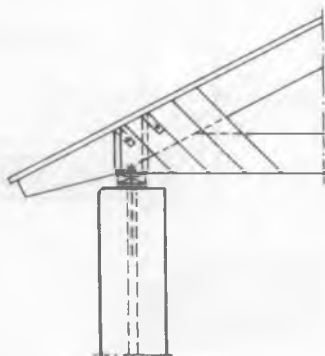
Крепление деревянной стропильной фермы к стене из ячеистобетонных плит болтами, заделанными в вертикальный шов между плитами
